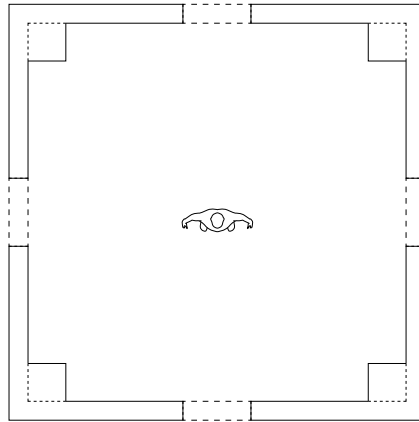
Pos. I.III | Grundriss – M.1:100
